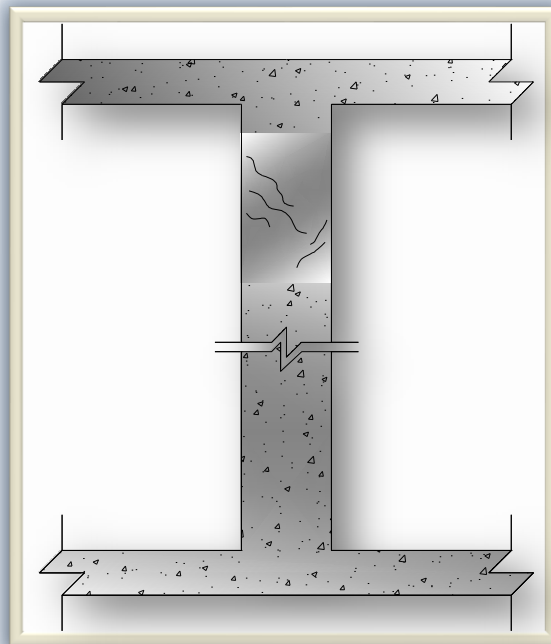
a.1-2) Otras demostraciones de fallas por tensión diagonal (cortante) que siempre provocan grietas diagonales, no obstante existan elementos adicionales de contención o restricción de cargas laterales
